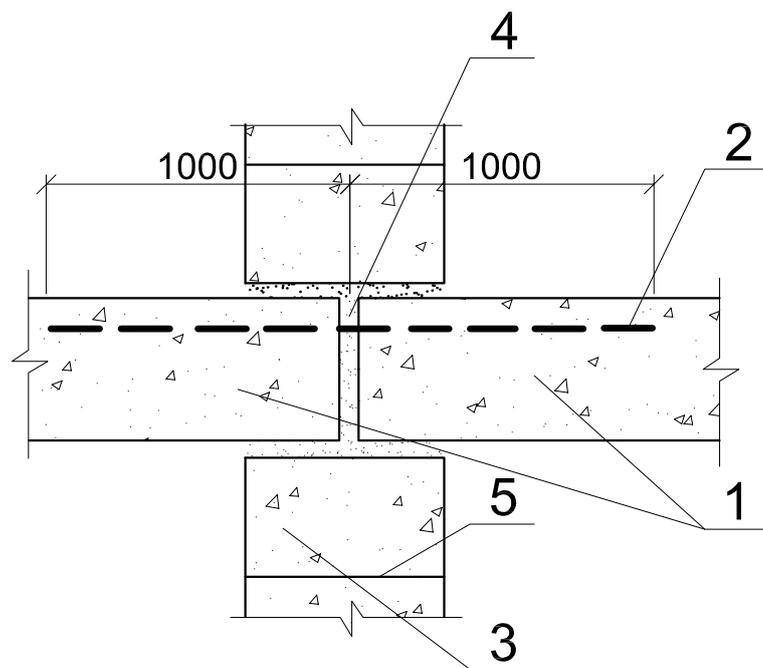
Опираие газобетонных плит перекрытия на внутреннюю стену из мелких блоков в зоне нулевого цикла
